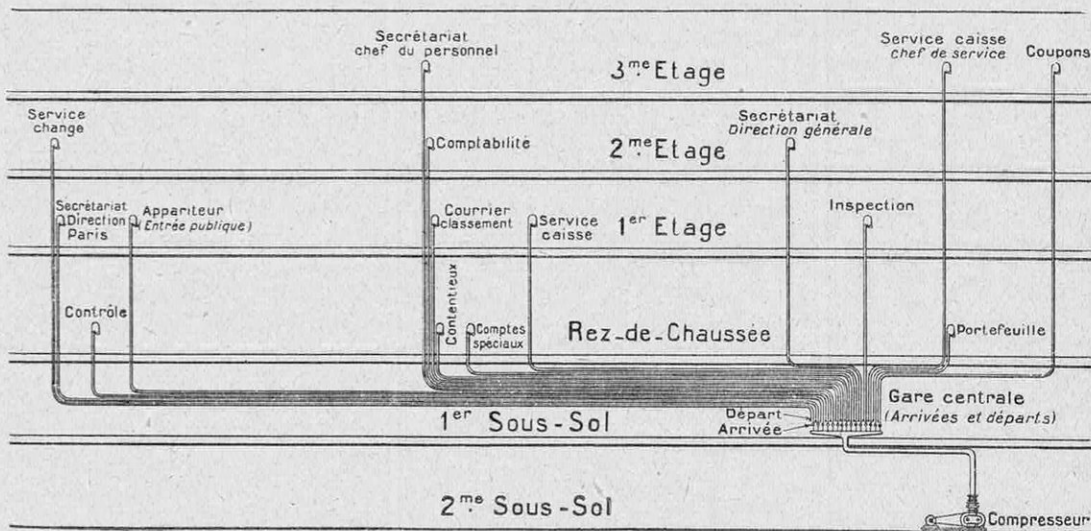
INSTALLATION DES TUBES PNEUMATIQUES DANS UNE BANQUE (DUPONT)
